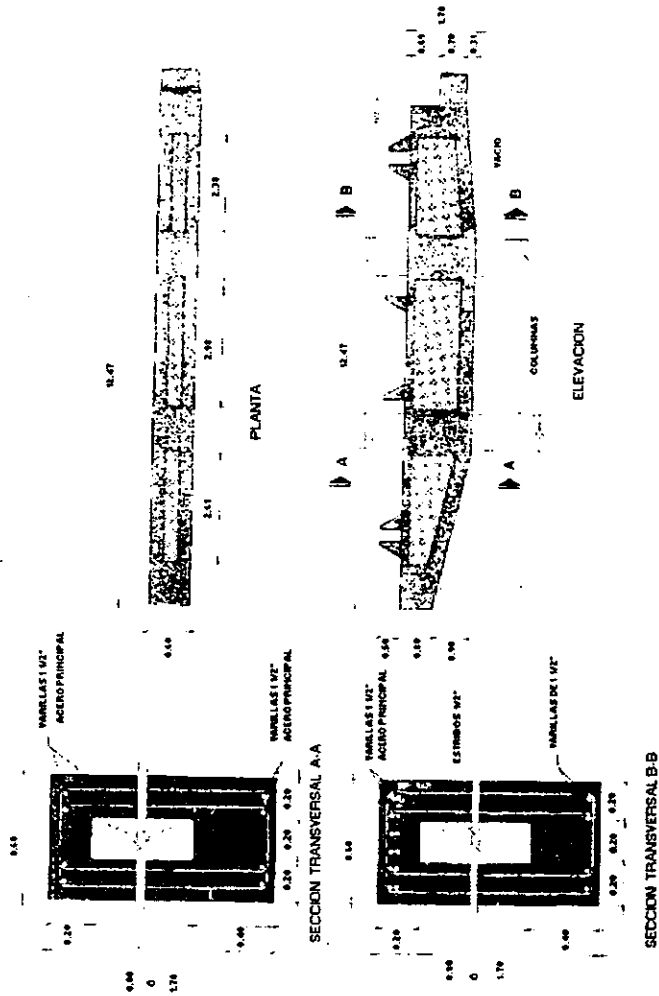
PLANTA, SECCION TRANSVERSAL, ELEVACION DE LAS TUBERIAS PRINCIPALES DE SOPORTE
